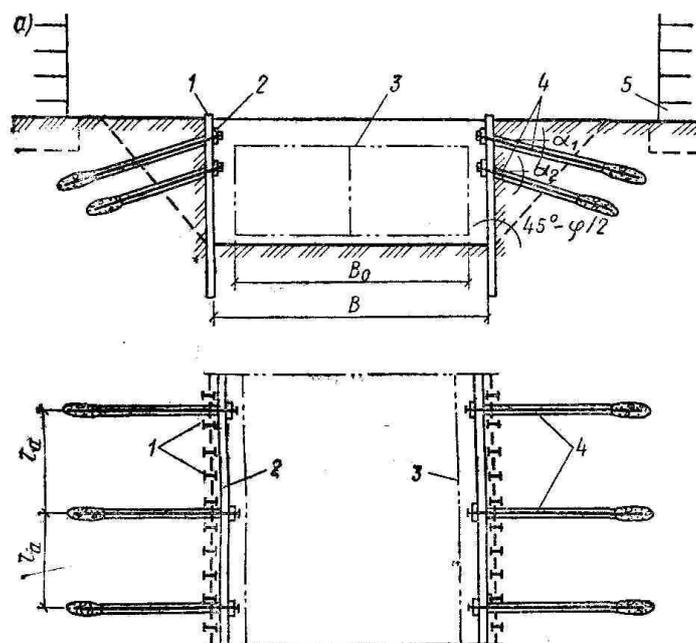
Схема анкерного крепления котлована: 1 – свая; 2 – пояса; 3 – контур подземного сооружения; 4 – анкеры; 5 – стойки
